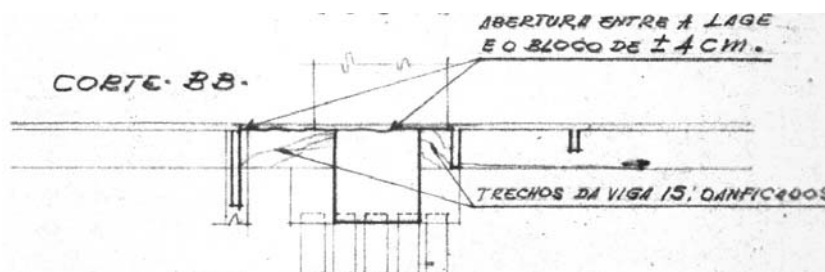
8 – Corte B-B do apoio central (Fonte: Pasta da Obra n° 1438, CRO-11, Brasília – 1974)
